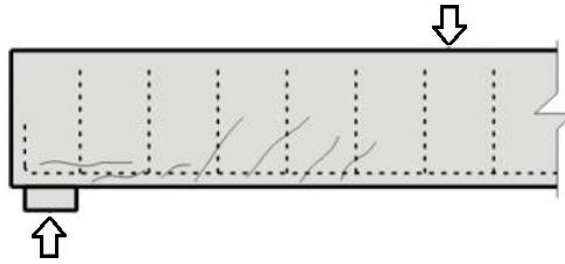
Fissuração na região de aderência das barras longitudinais devido ao cisalhamento (adaptado Fusco, 2008).
